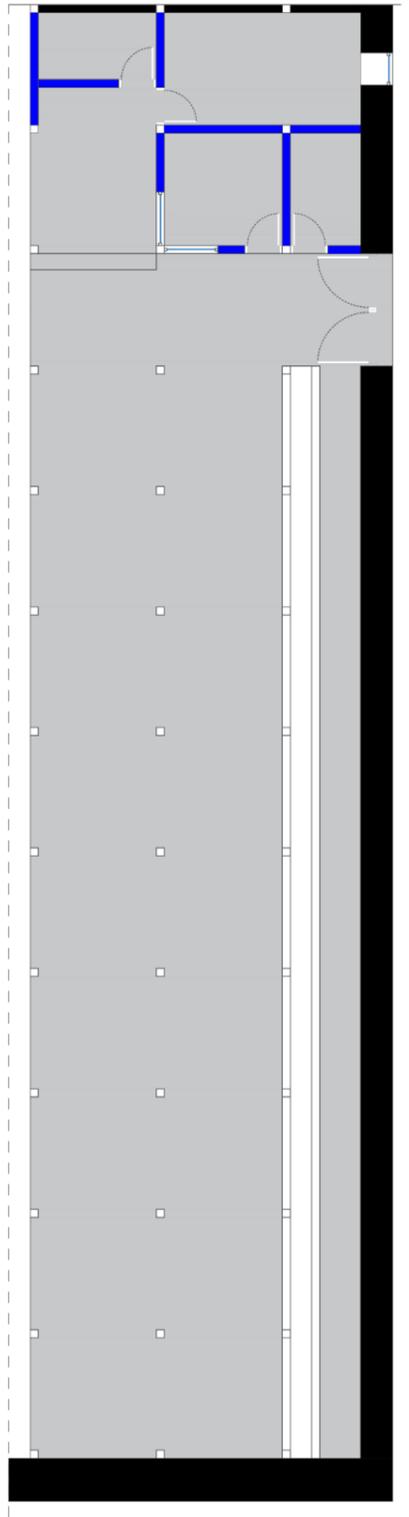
Planta Bloque 6 Elementos añadidos Fuente Luis Segovia 2023
